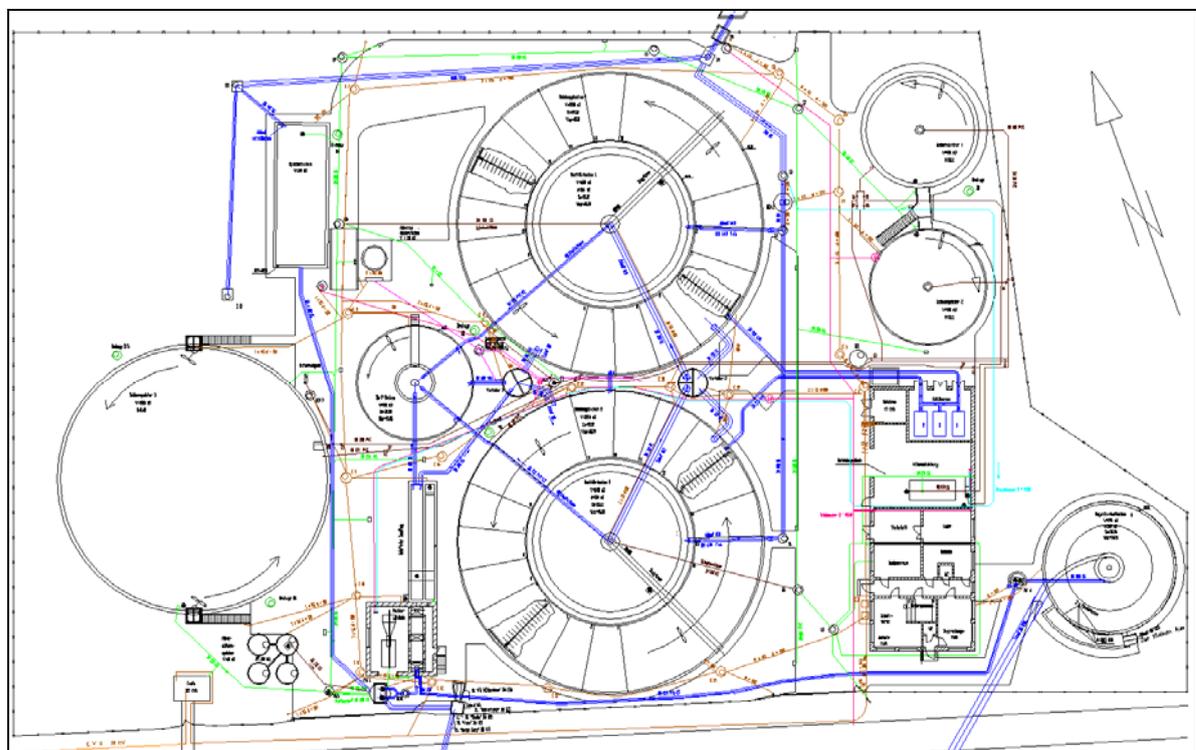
Lageplan Kläranlage Rahden, verbindende Rohrleitungen [Dinnendahl, 1993]
